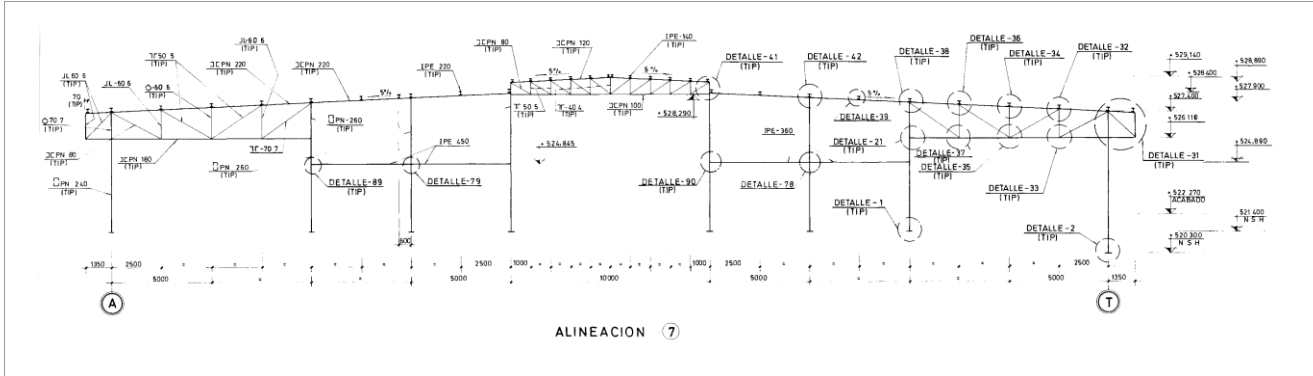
Estructura metálica – Pórtico en alineación 7
